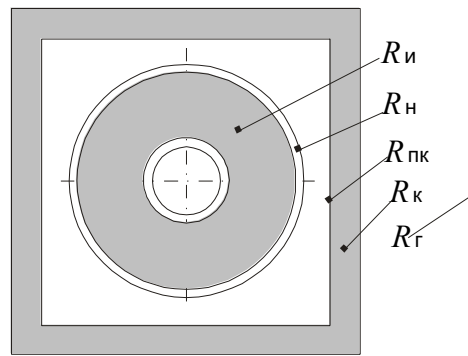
Схема канальной прокладки однетрубного теплопровода
